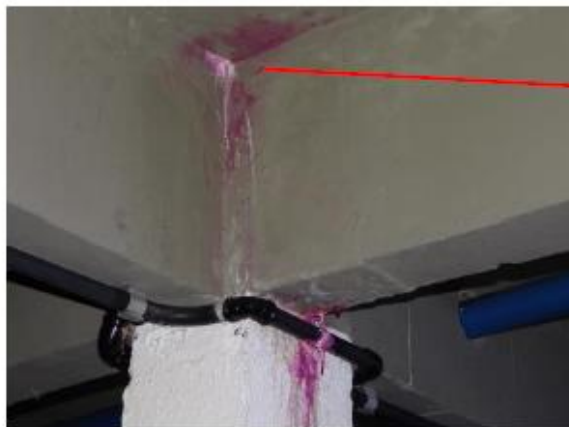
Detalhe 4 da infiltração no topo do pilar.
